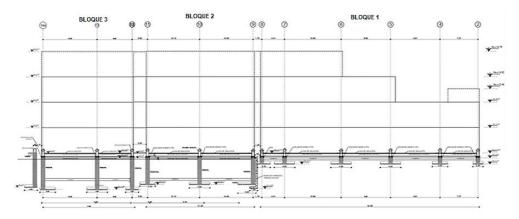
Bloque Estructural 1 con aisladores sísmicos, contiene a los Bloques Arquitectónicos 1, 2 y 3.
